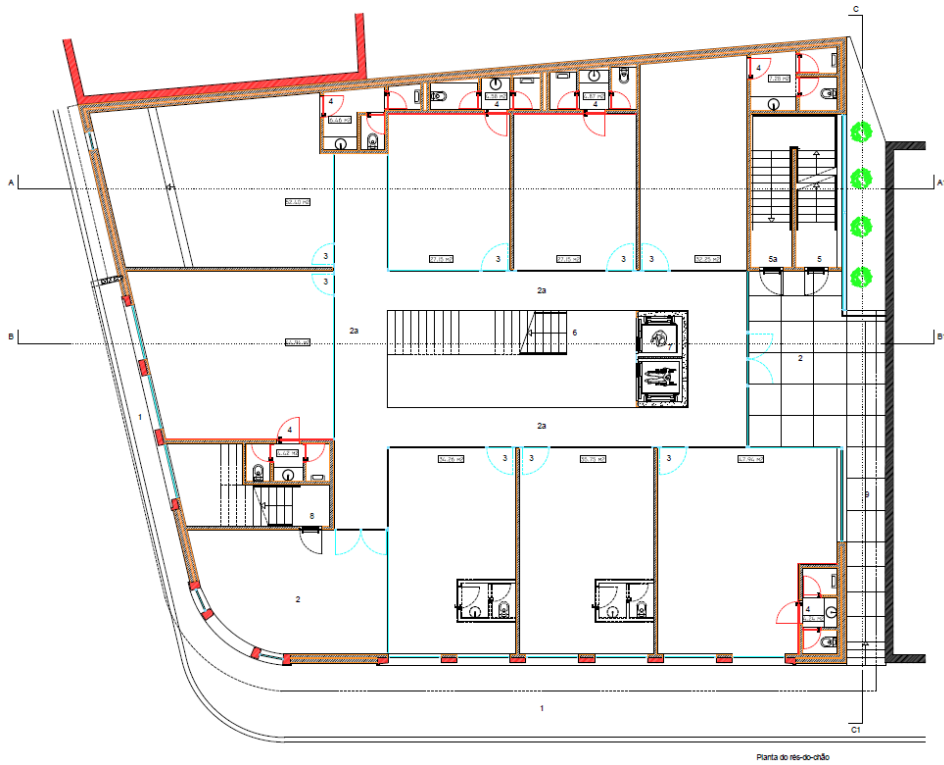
Planta do rés do chão. Fonte: Corcovado Construções.
